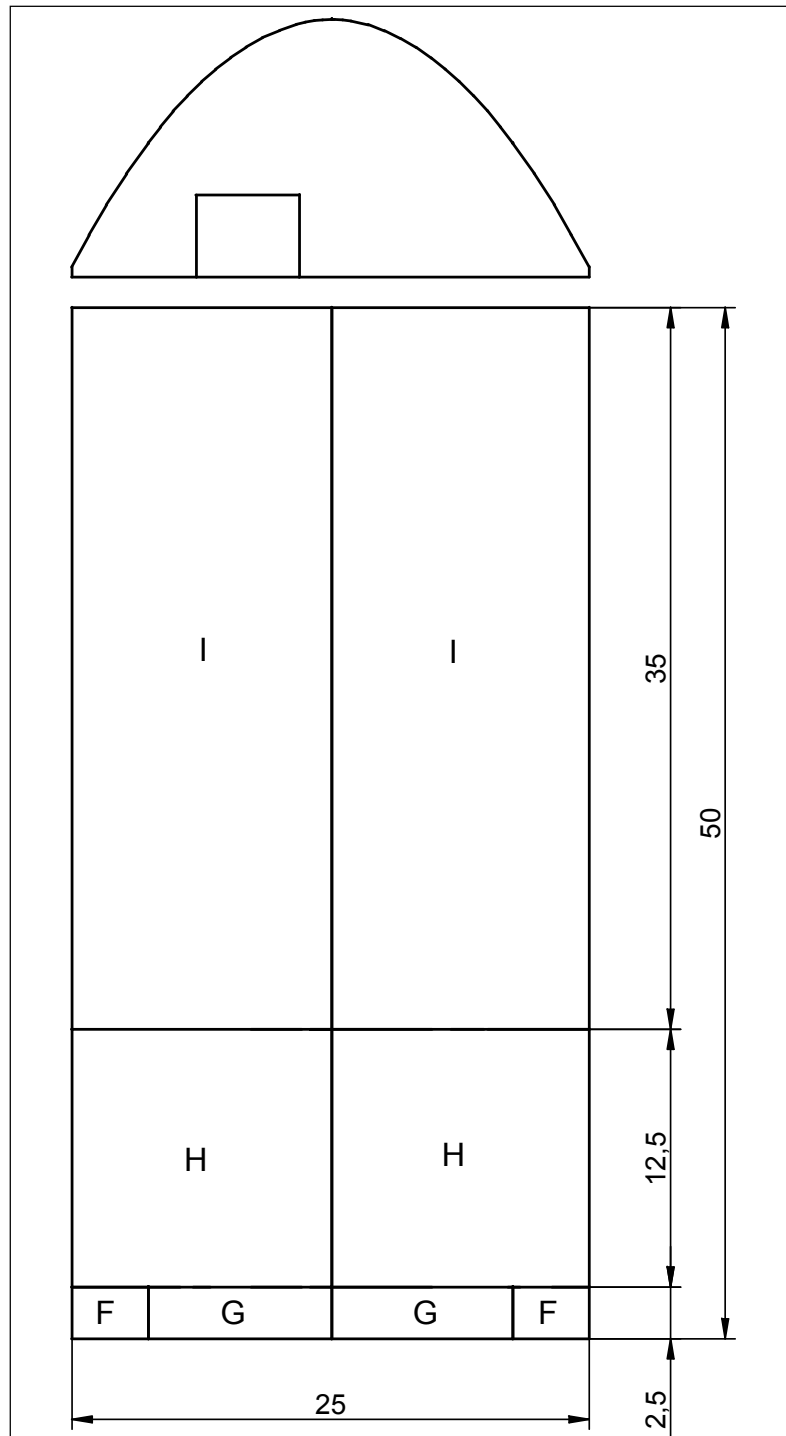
Zonas de carga en la cubierta en cúpula. Viento a 90°. Vista en planta
